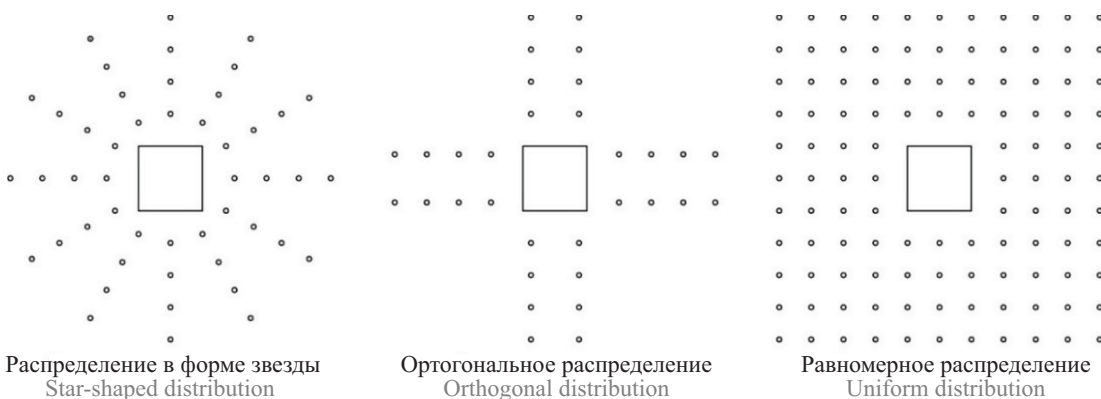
Виды распределения поперечной арматуры вокруг опоры
